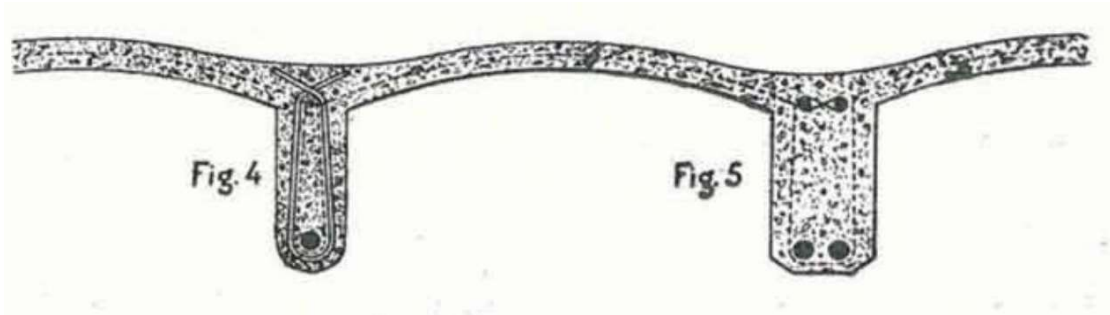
, detalle de la solución de vigas, viguetas y bóvedas en el Sistema Ribera, del libro Hormigón y cemento armado, mis sistemas y mis obras de José Eugenio Ribera (1902)
